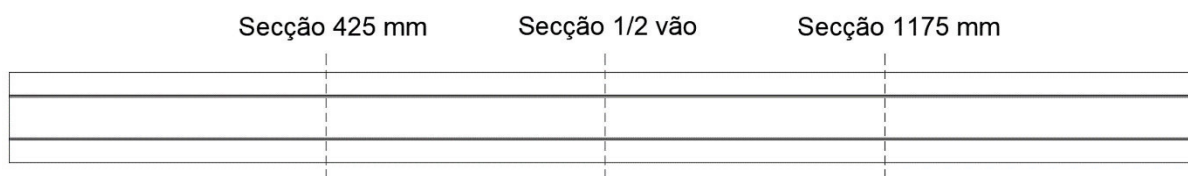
Vista em planta do provete  $\Omega$  90° com a indicação da posição das secções em análise.
